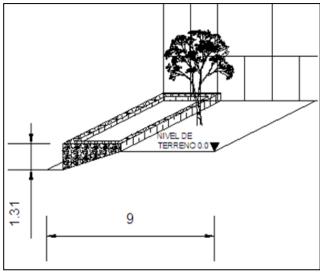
Área designada a la planta de biogás Figura 4.6 Desnivel en el área propuesta
